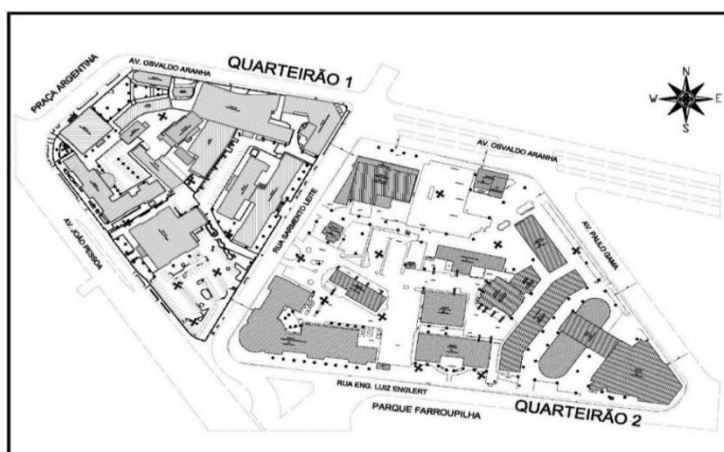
Planta baixa do Campus Centro da UFRGS, Porto Alegre, RS, dividido em Quarteirão 1 e 2
